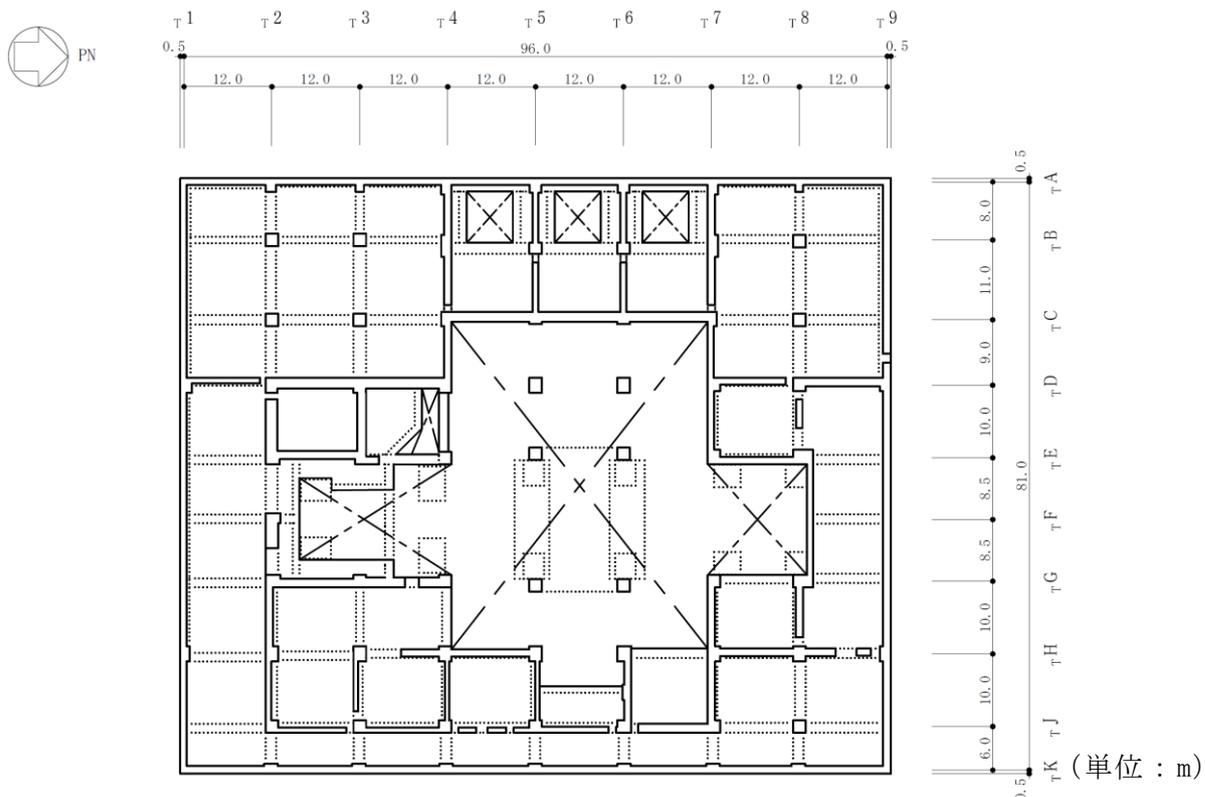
タービン建屋の概略平面図（B1F, T.M.S.L. 4.9m）（2/6）
